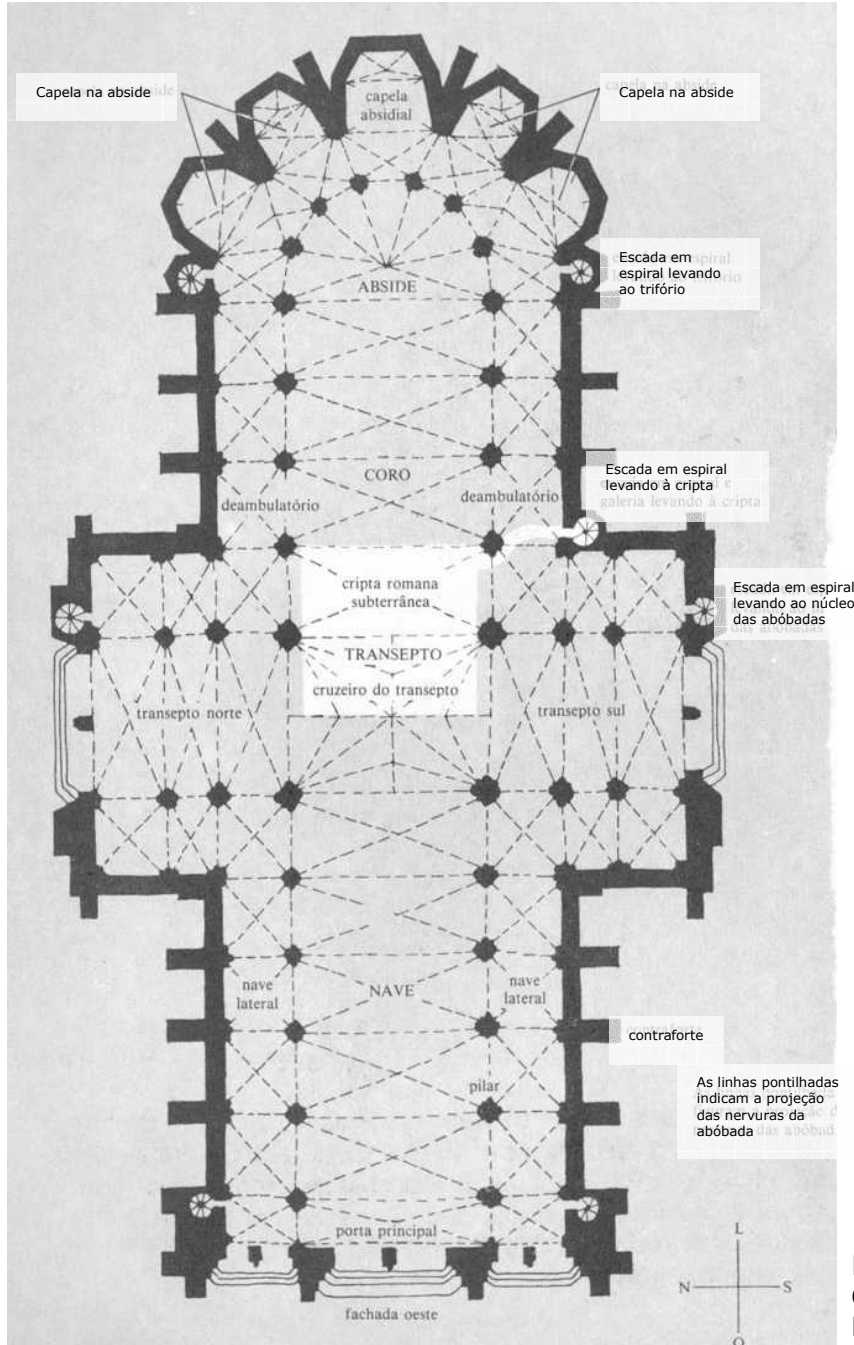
Esquemas de planta e corte tipos para catedral gótica em Chutreaux, 1252-arquiteto: Guillaume.
